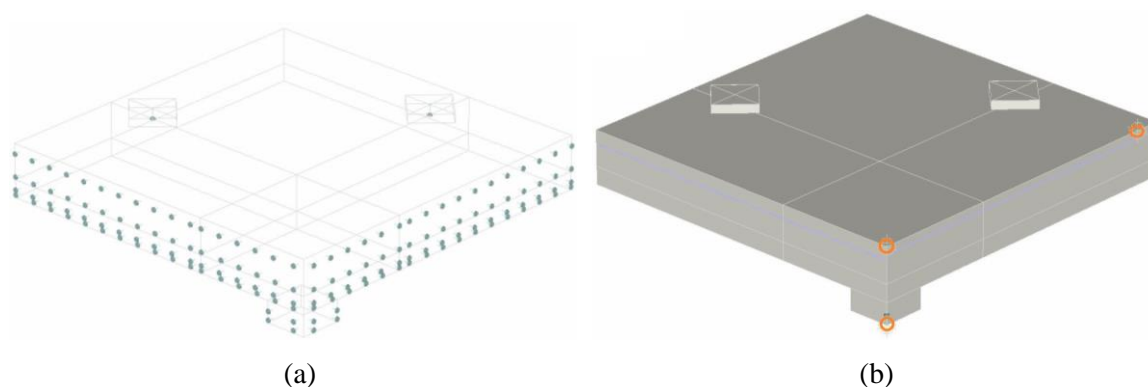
Modelo numérico da laje SHSC7: (a) discretização da malha e (b) armadura longitudinal superior.
